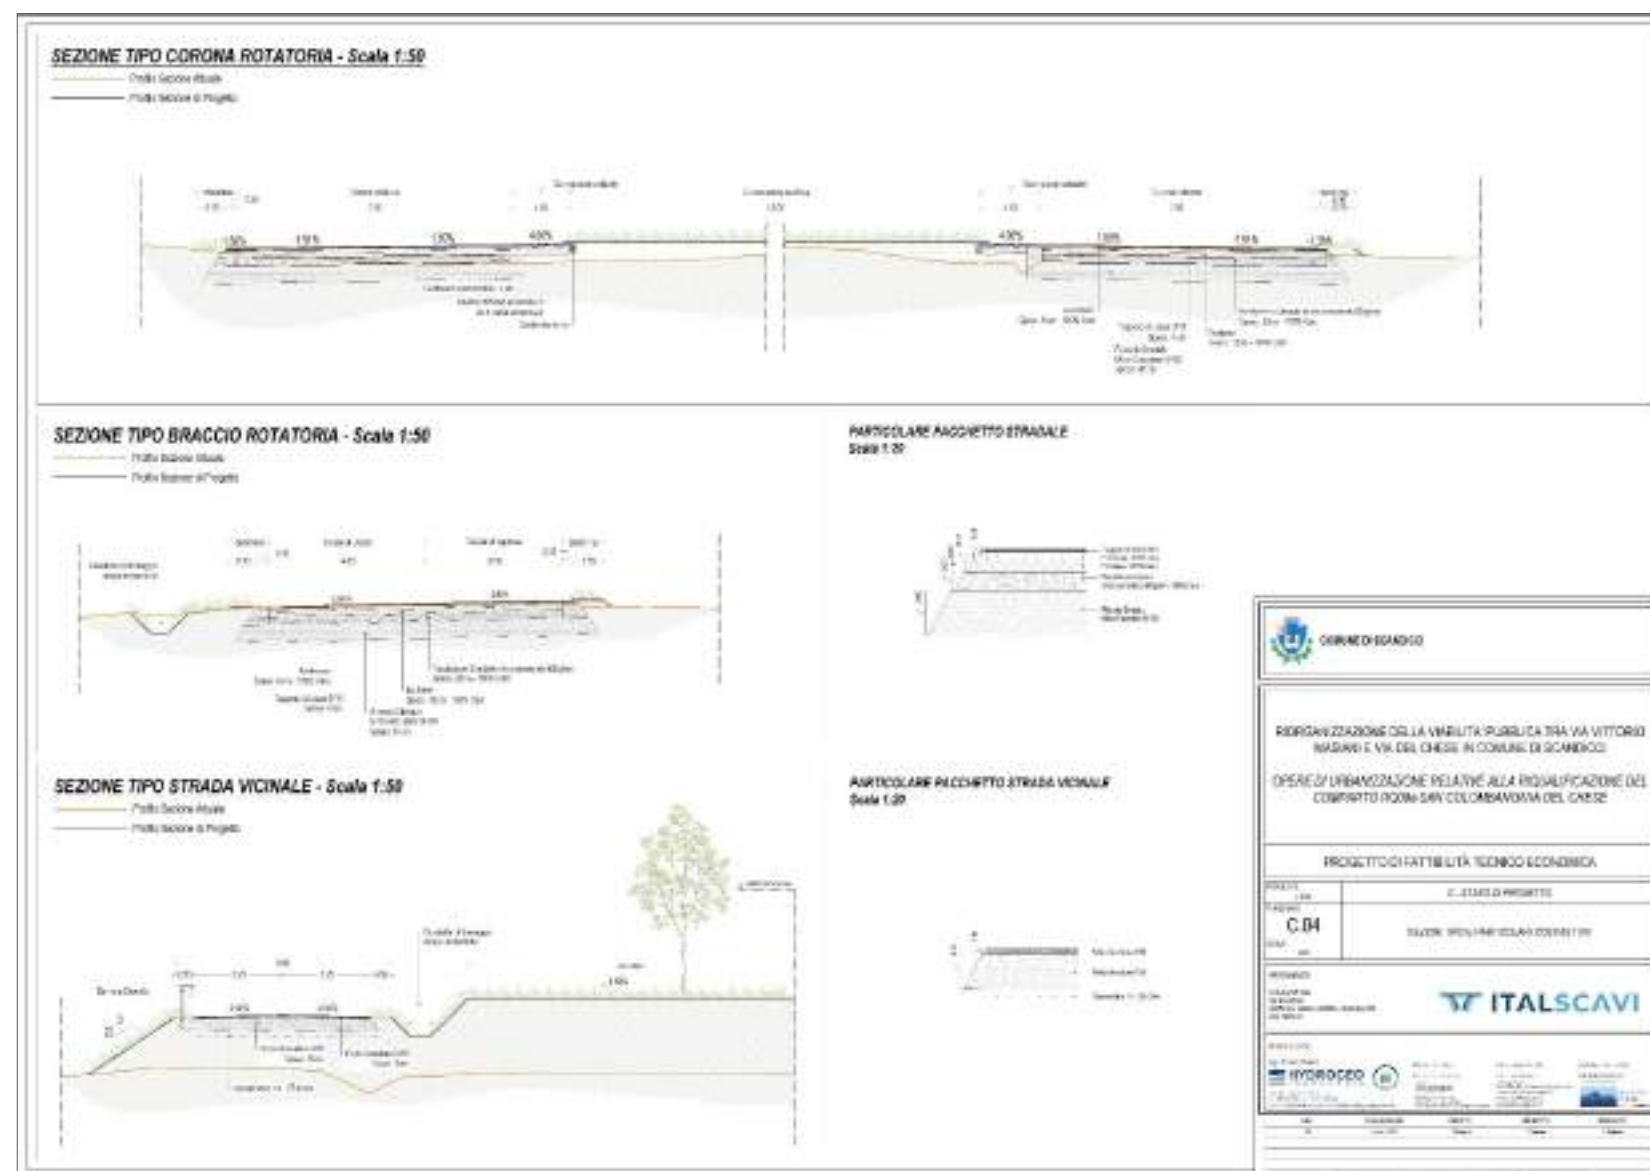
Documentazione tecnica con Sezioni Tipo degli interventi di scavo e di riporto previsti dal progetto.
